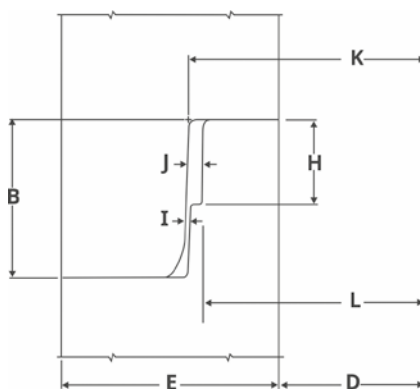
Geometría de las juntas de tuberías para diámetros mayores a 1200 mm
